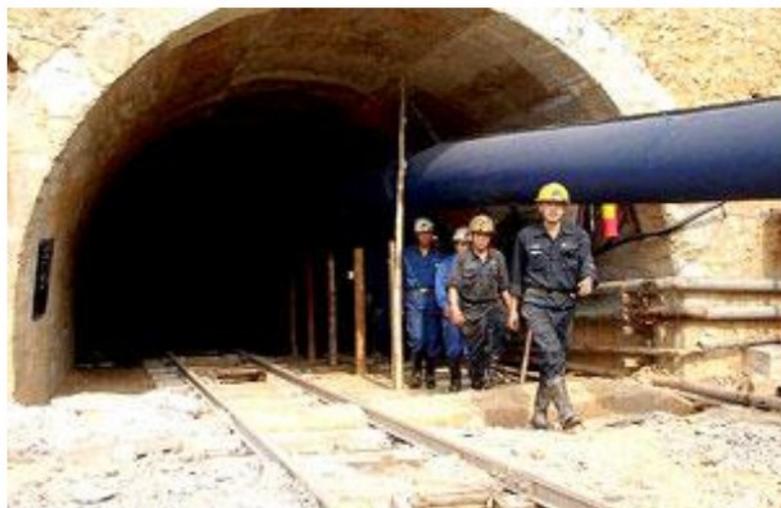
Монолитные бетонные, железобетонные и металлобетонные крепи
